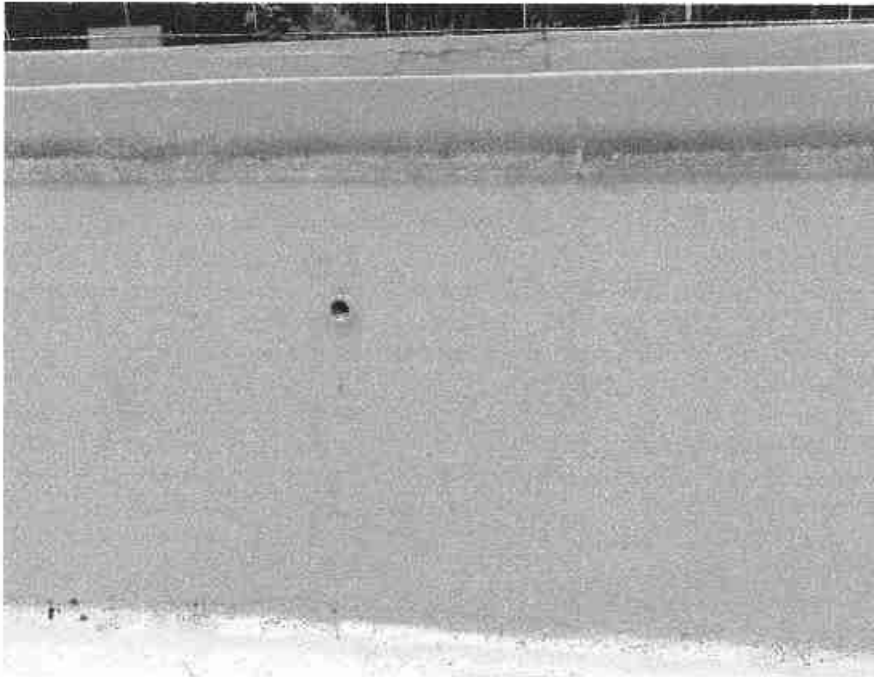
Grieta en la unión entre piso y la pared.
